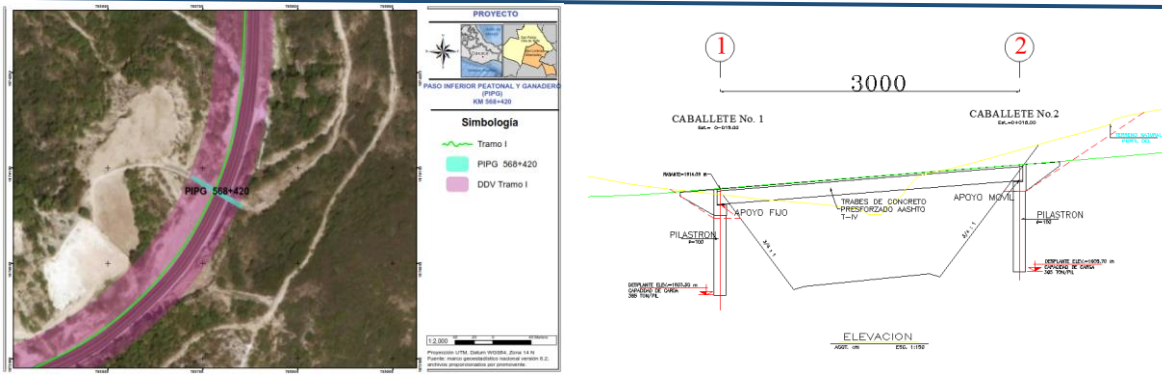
Proyecto en planta y corte longitudinal del PIPG 568+420.
